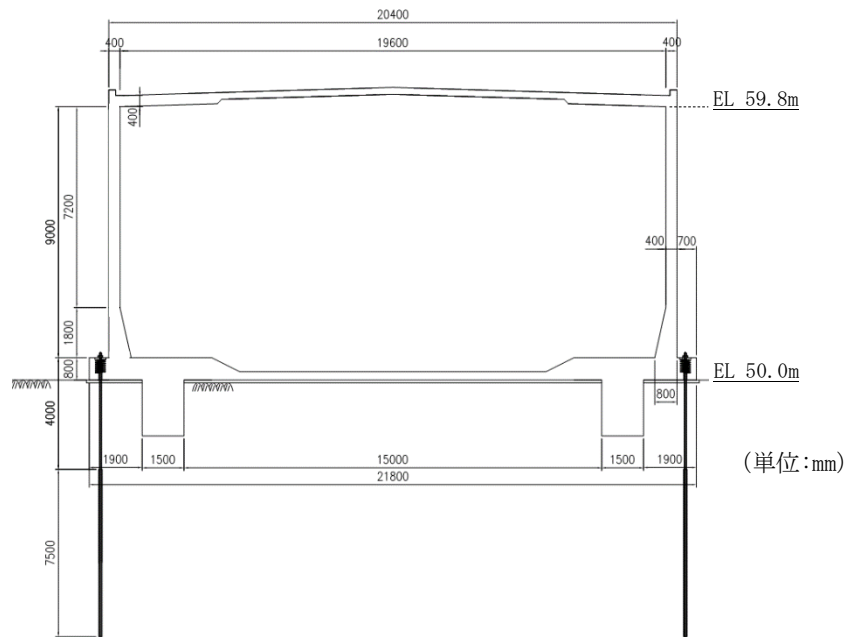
非常用ろ過水タンク 断面図 (A-A断面)
